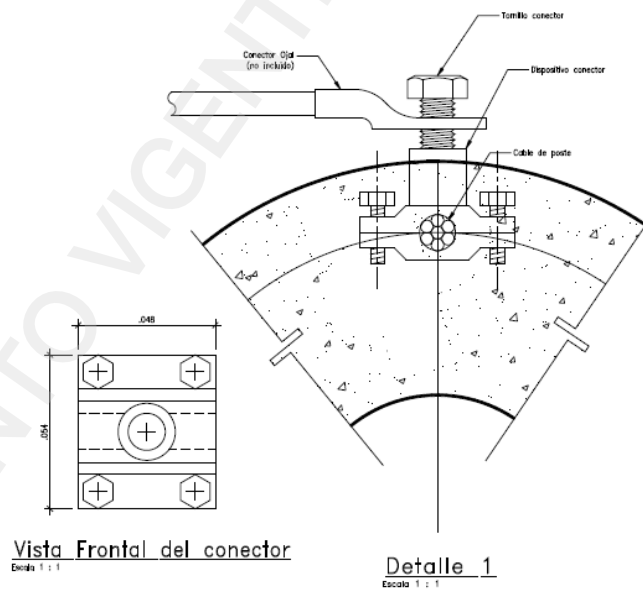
Detalle de instalación del dispositivo de aterrizaje del poste de concreto
